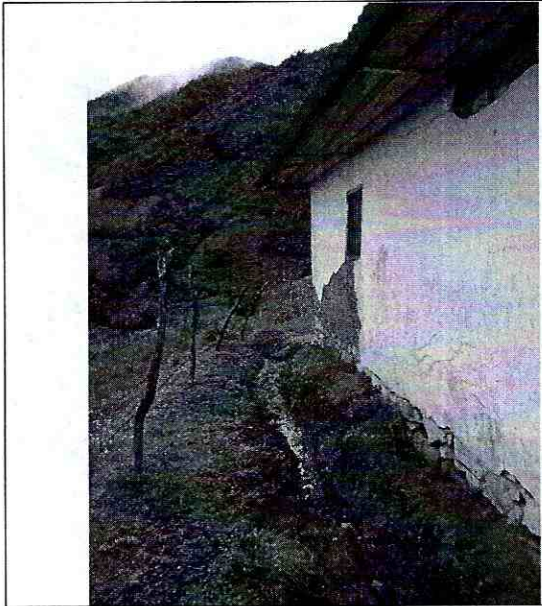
Afectaciones al interior de la vivienda – Se observan sobre el mortero de recubrimiento
